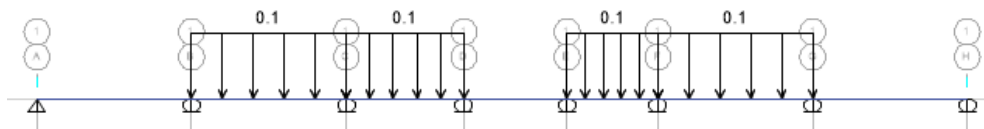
Carga viva distribuida en vigueta de losa aligerada – Damero 4
